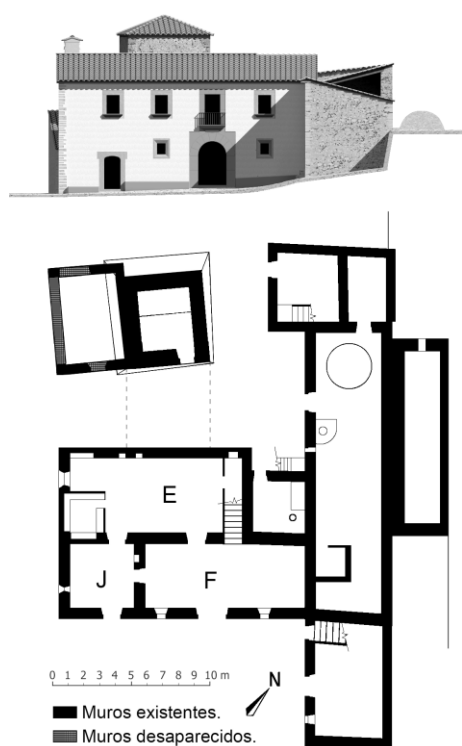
Planta y alzados de las cuatro casas en las que estaba dividida *Son Moner* en 1685, Fase 8.
